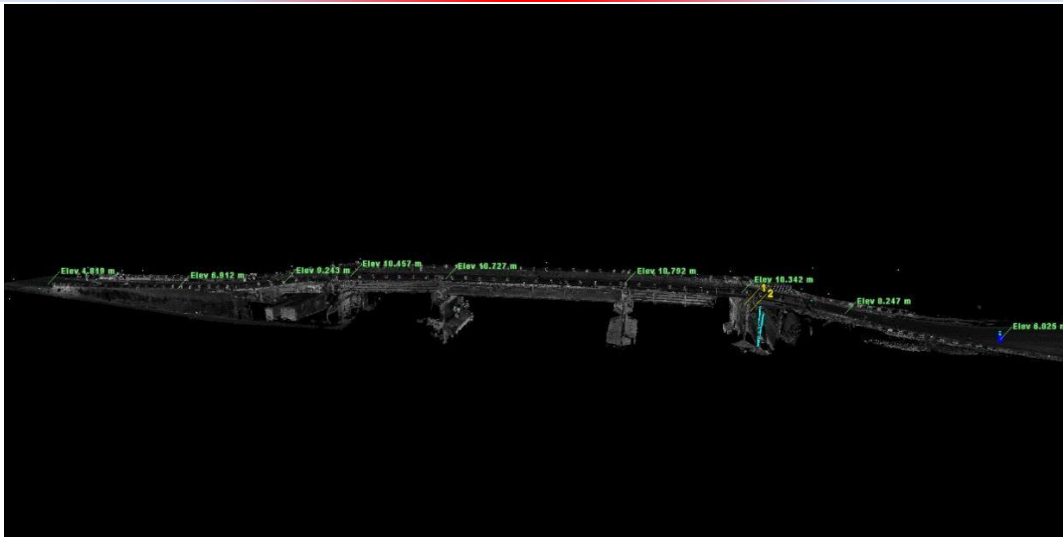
Geometri Panjang Bentang Abutmen Jalan Pendekat menuju Pilar-1
